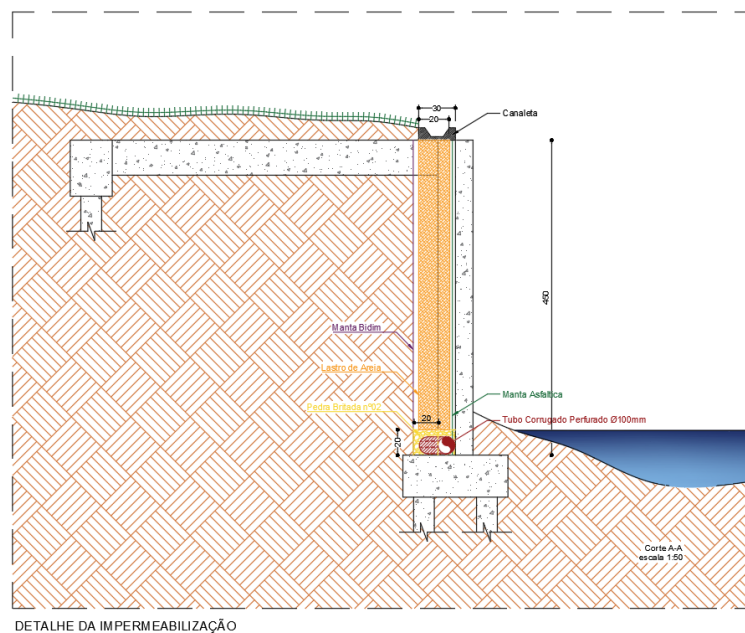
Muro de Contenção com impermeabilização e drenagem
